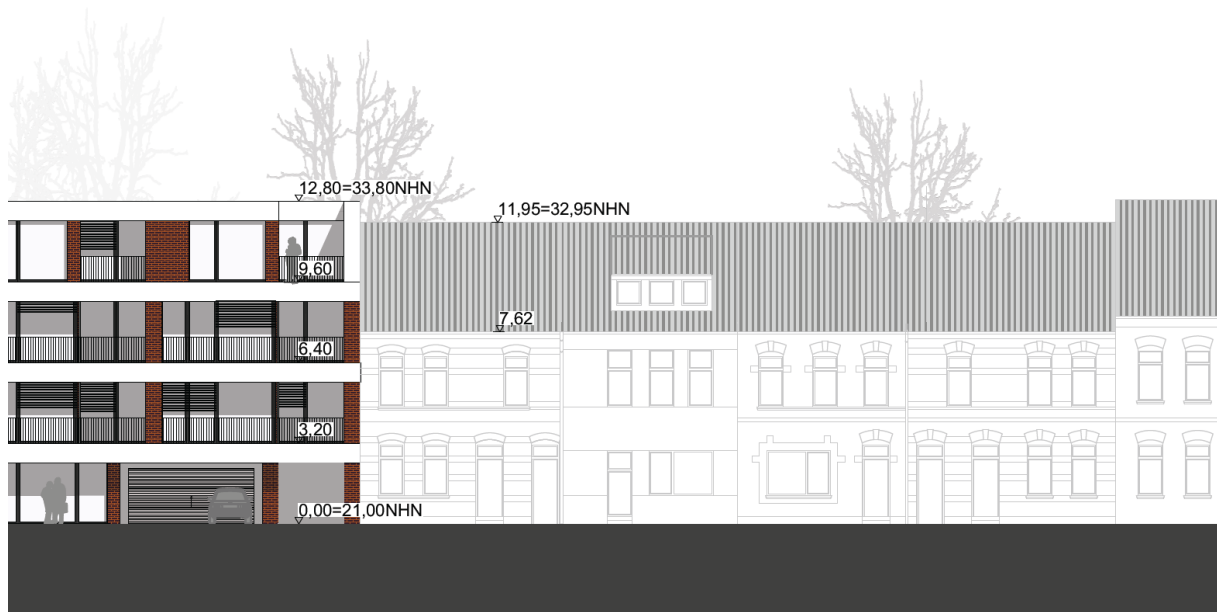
Ansicht der bestehenden und geplanten Bebauung entlang der Rheinstraße (Architekturbüro Josef Dalman, 2023)
